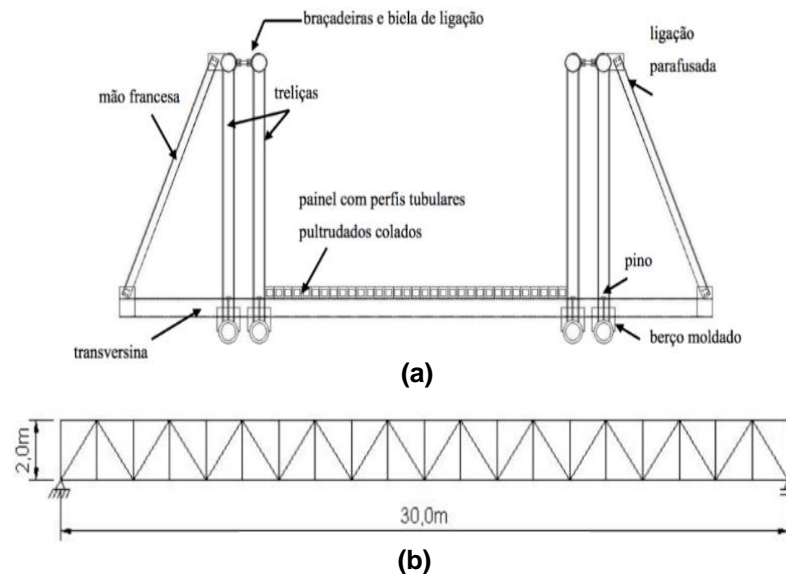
Ponte Desmontável: (a) seção transversal, (b) esquema estrutural das vigas
